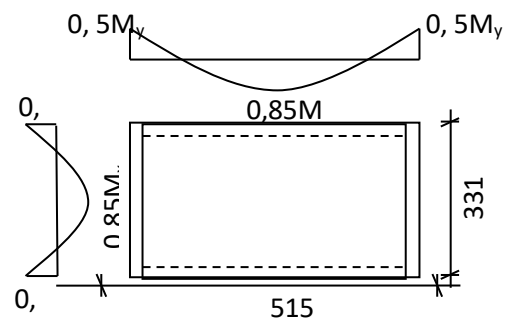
Panneau de dalle appuyé sur 4 coté.
